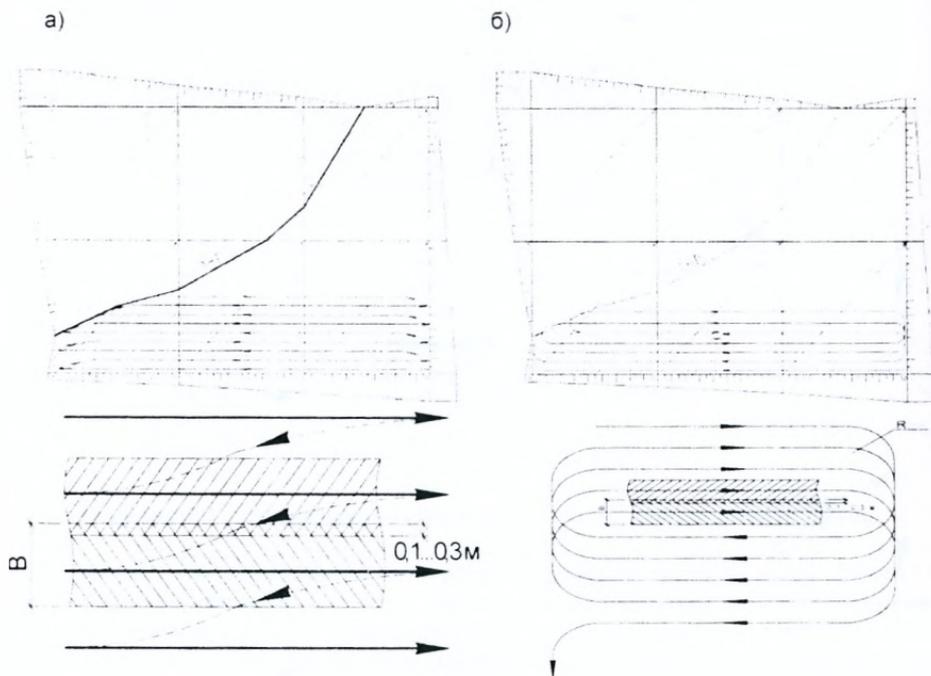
Схема разравнивания грунта при устройстве насыпи
